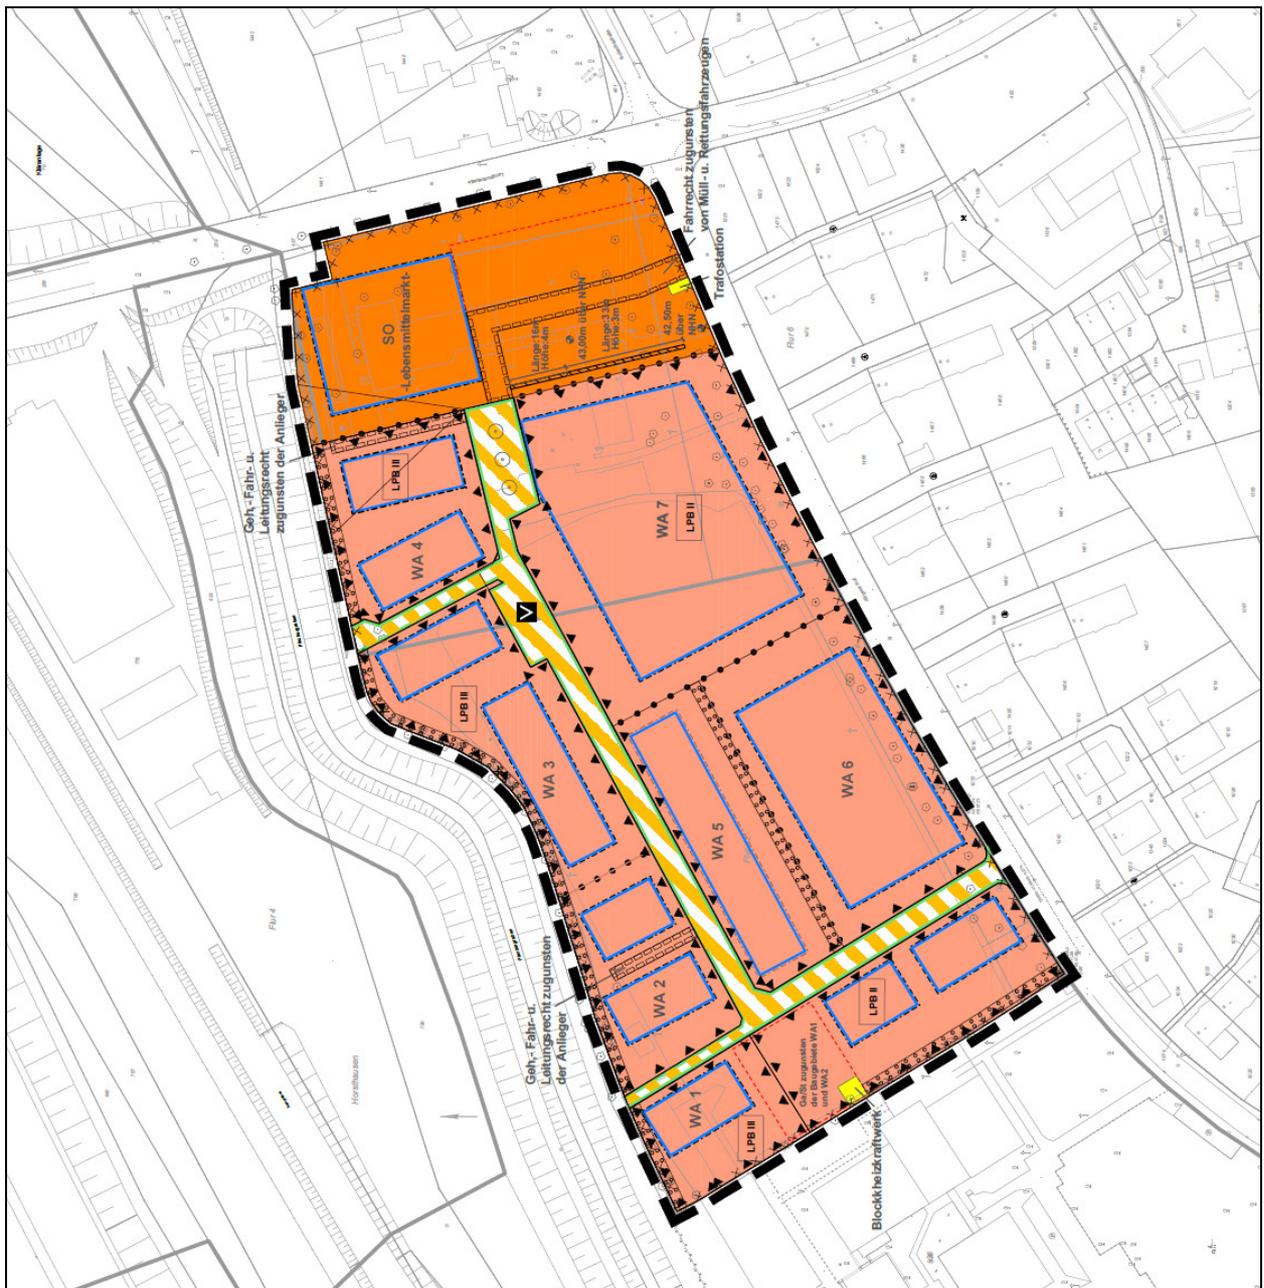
Bebauungsplan – Vorentwurf (unmaßstäblich)
